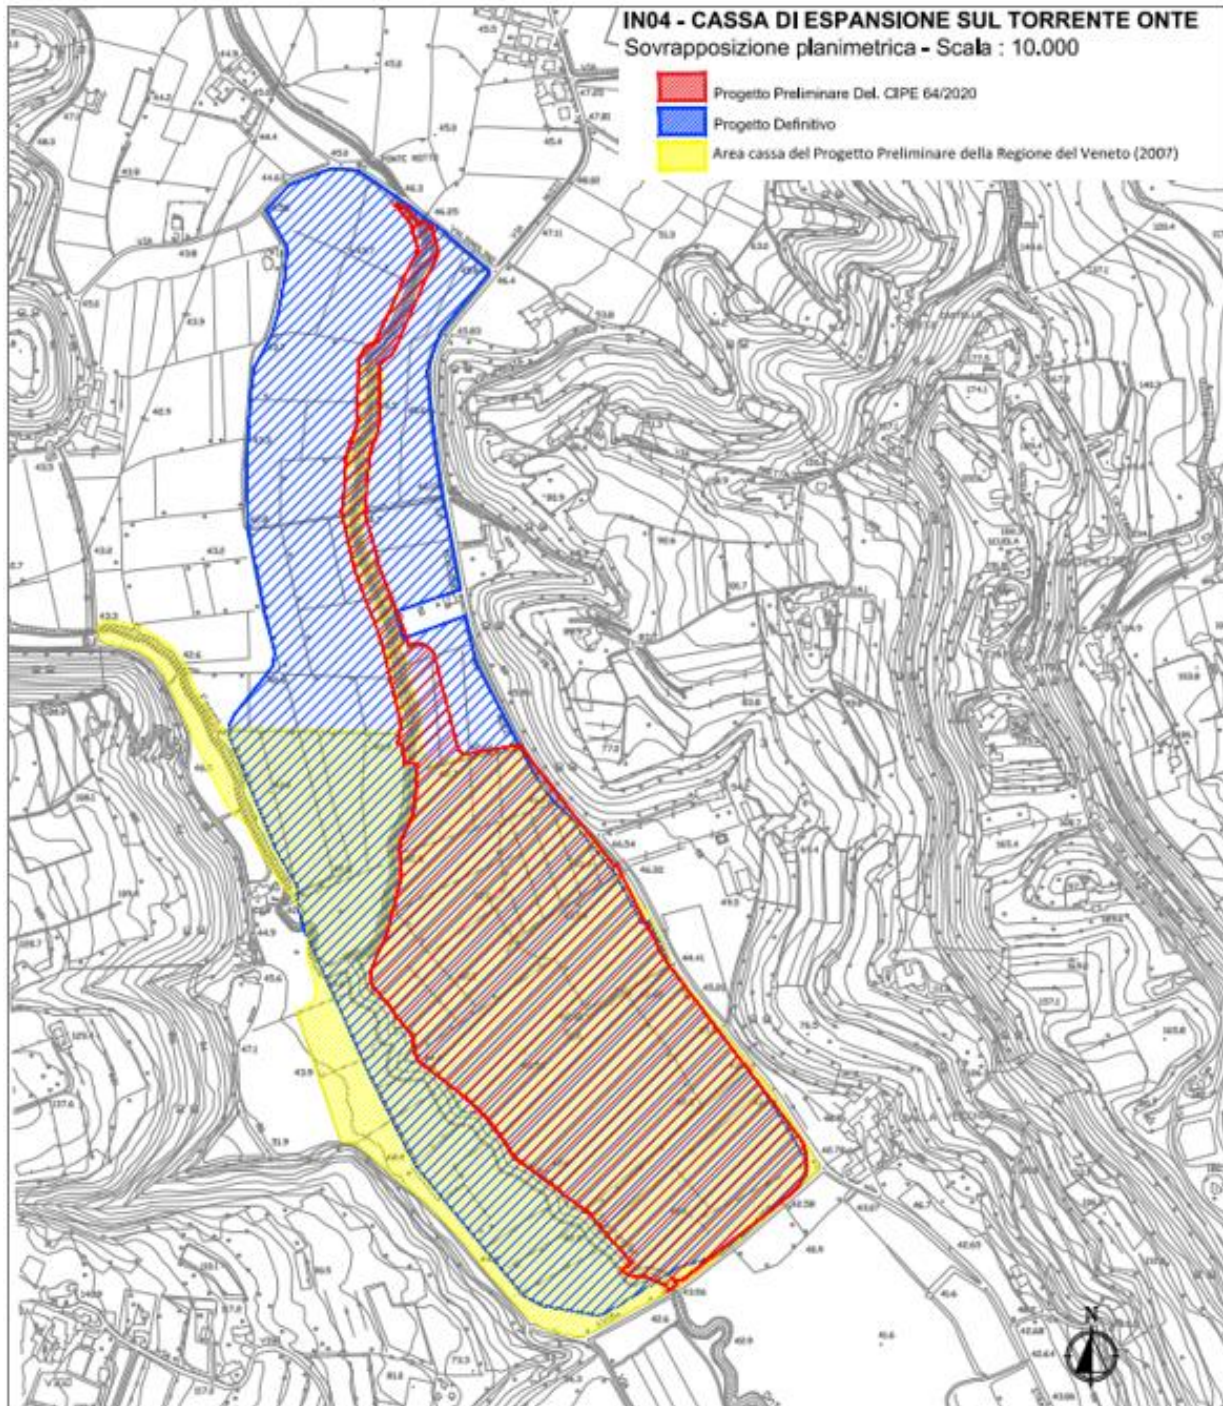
Cassa di espansione sul T.Onte – Planimetria confronto PP Reg\_Veneto 2003 - PP Italferr- PD
